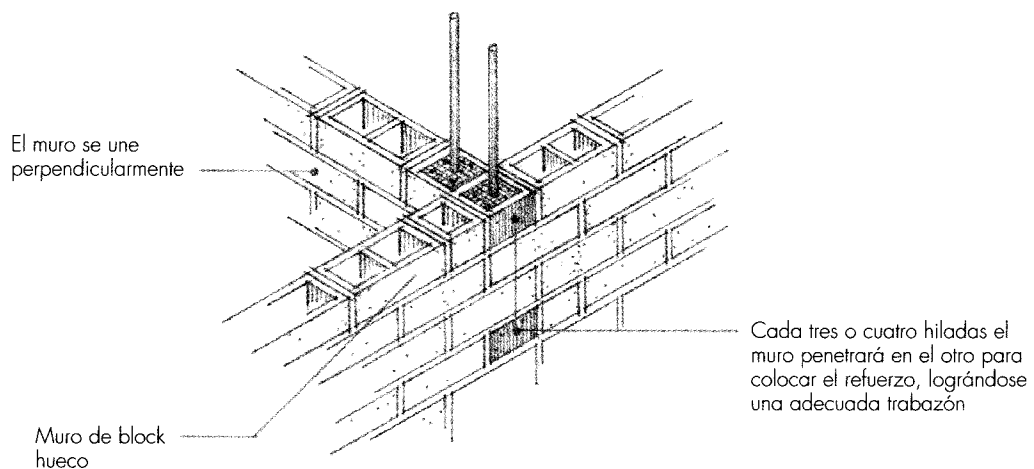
Refuerzo vertical en la unión de dos muros a tope.
